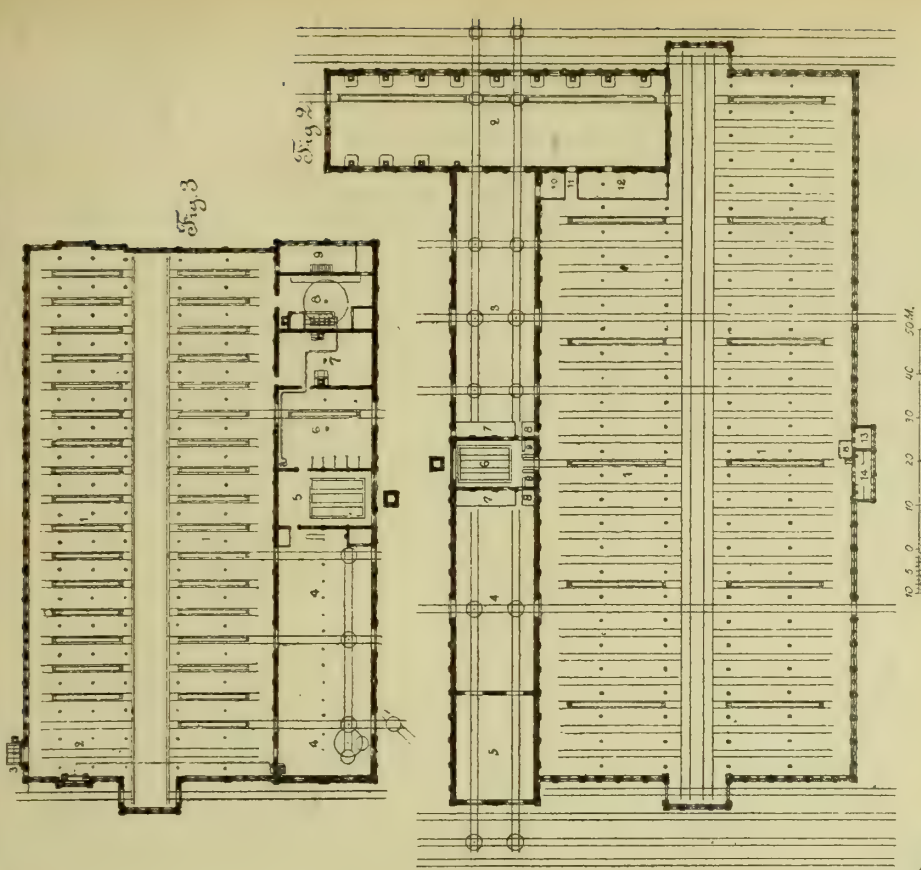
Grundriss der Lokomotiv-Reparatur.
